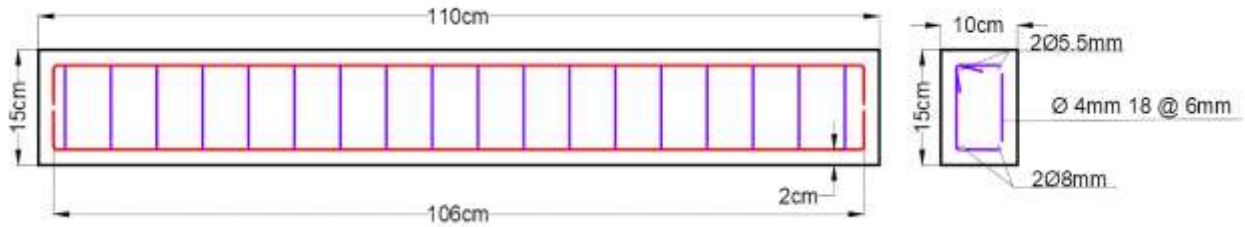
Detalle de armado y recubrimiento de 1 cm
